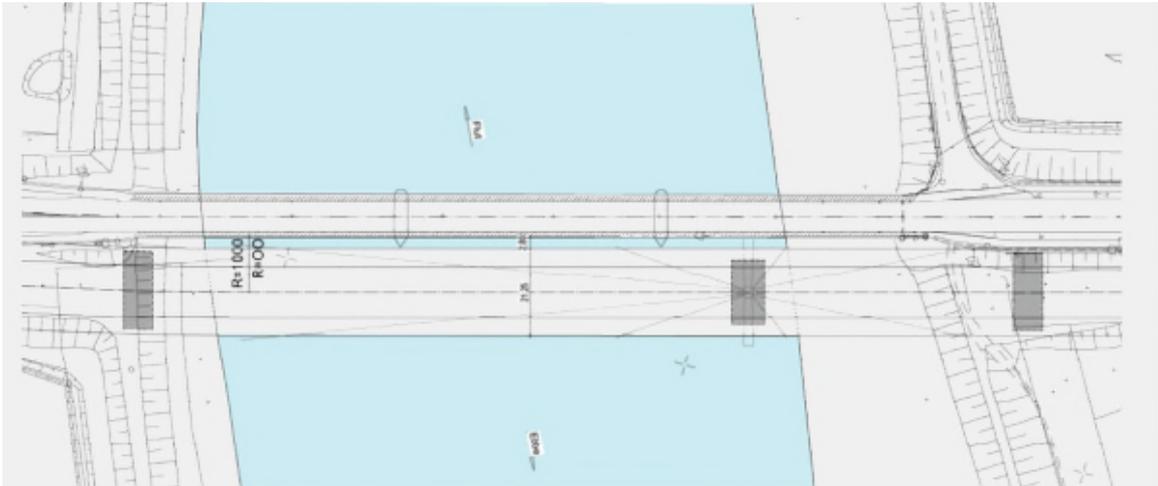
Lageplan der Überbauvariante 3.2 Schrägkabelbrücke in Verbindung mit Trassenvariante 1 gemäß /3/
